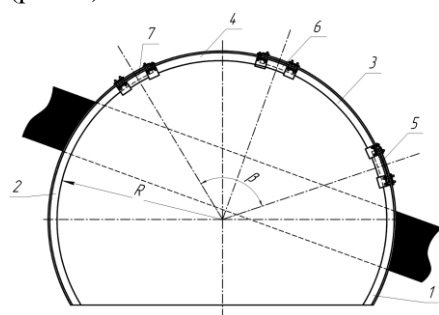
Предлагаемая конструкция крепи: 1,2 - стойки крепи; 3 - элемент составного верхняка; 4 - верхняк; 5,6 и 7 - узлы соединения несущих элементов
